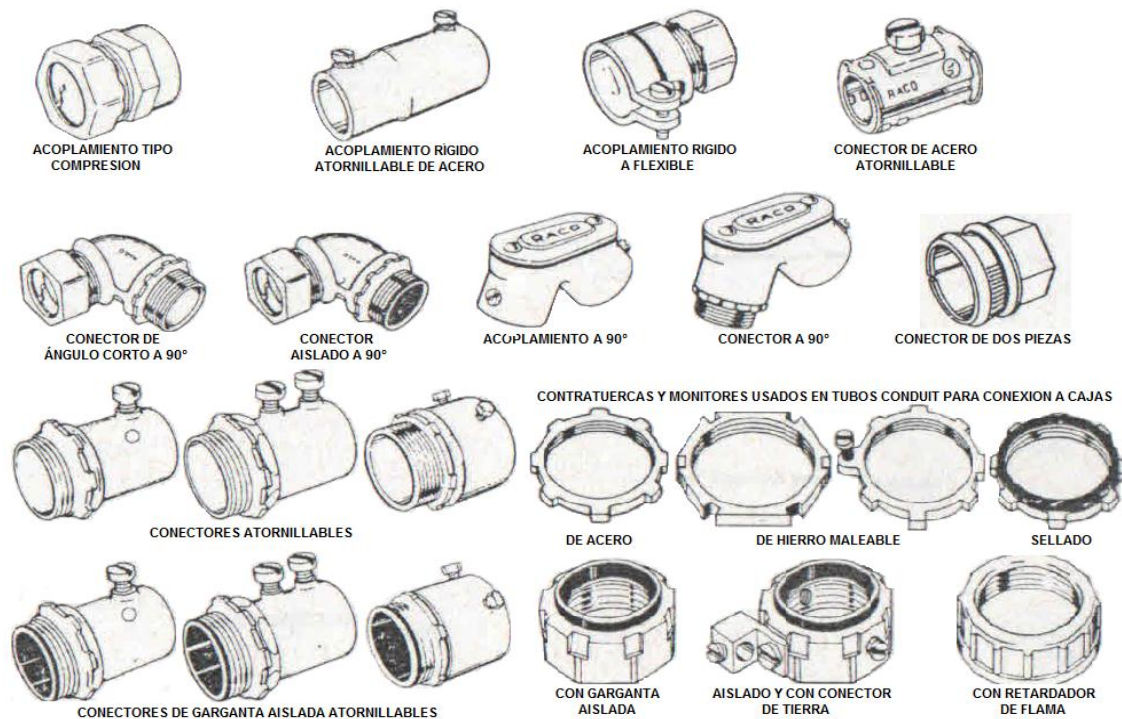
Adaptadores de tubo conduit metálico rígido de pared delgada
